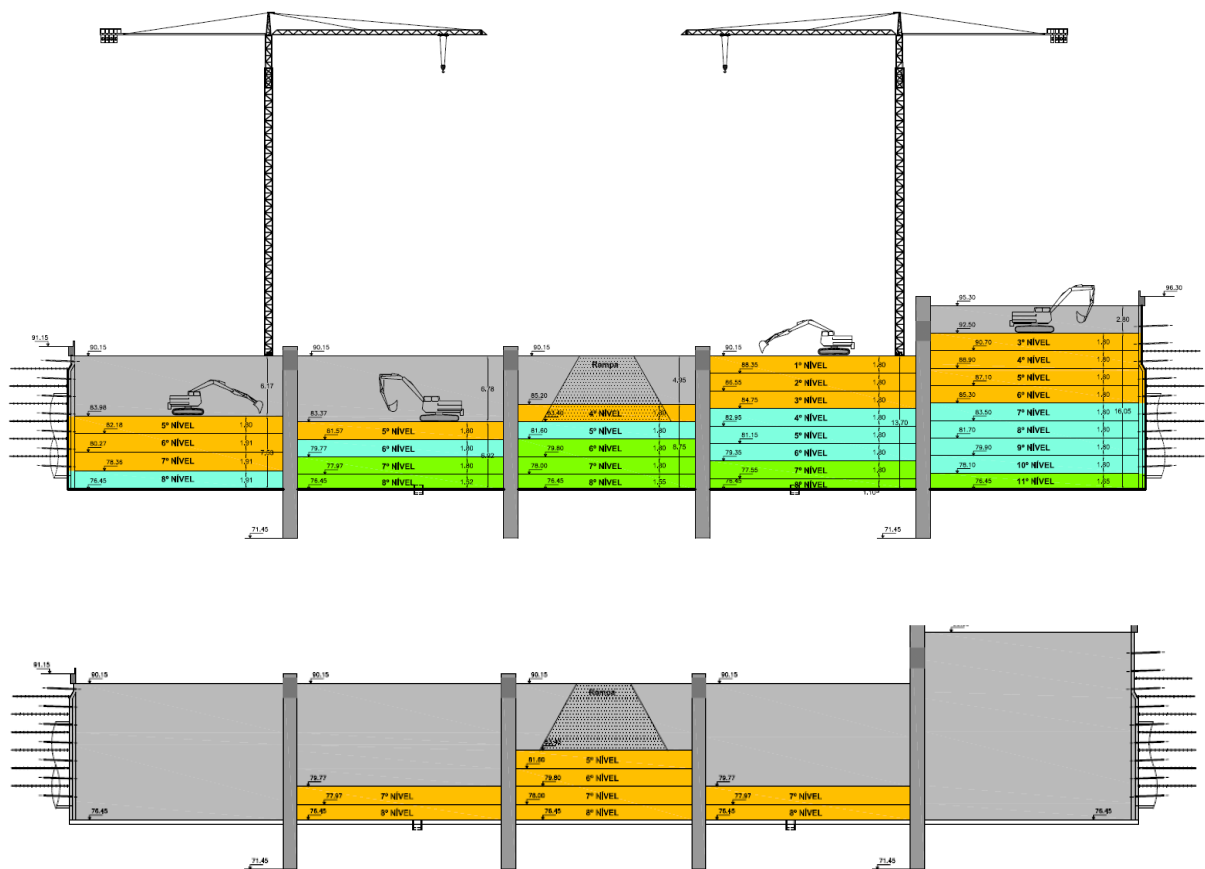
Esquemas da geometria adotada relativamente aos níveis de escavação, em duas fases diferentes da escavação (NE ACE, 2009).
